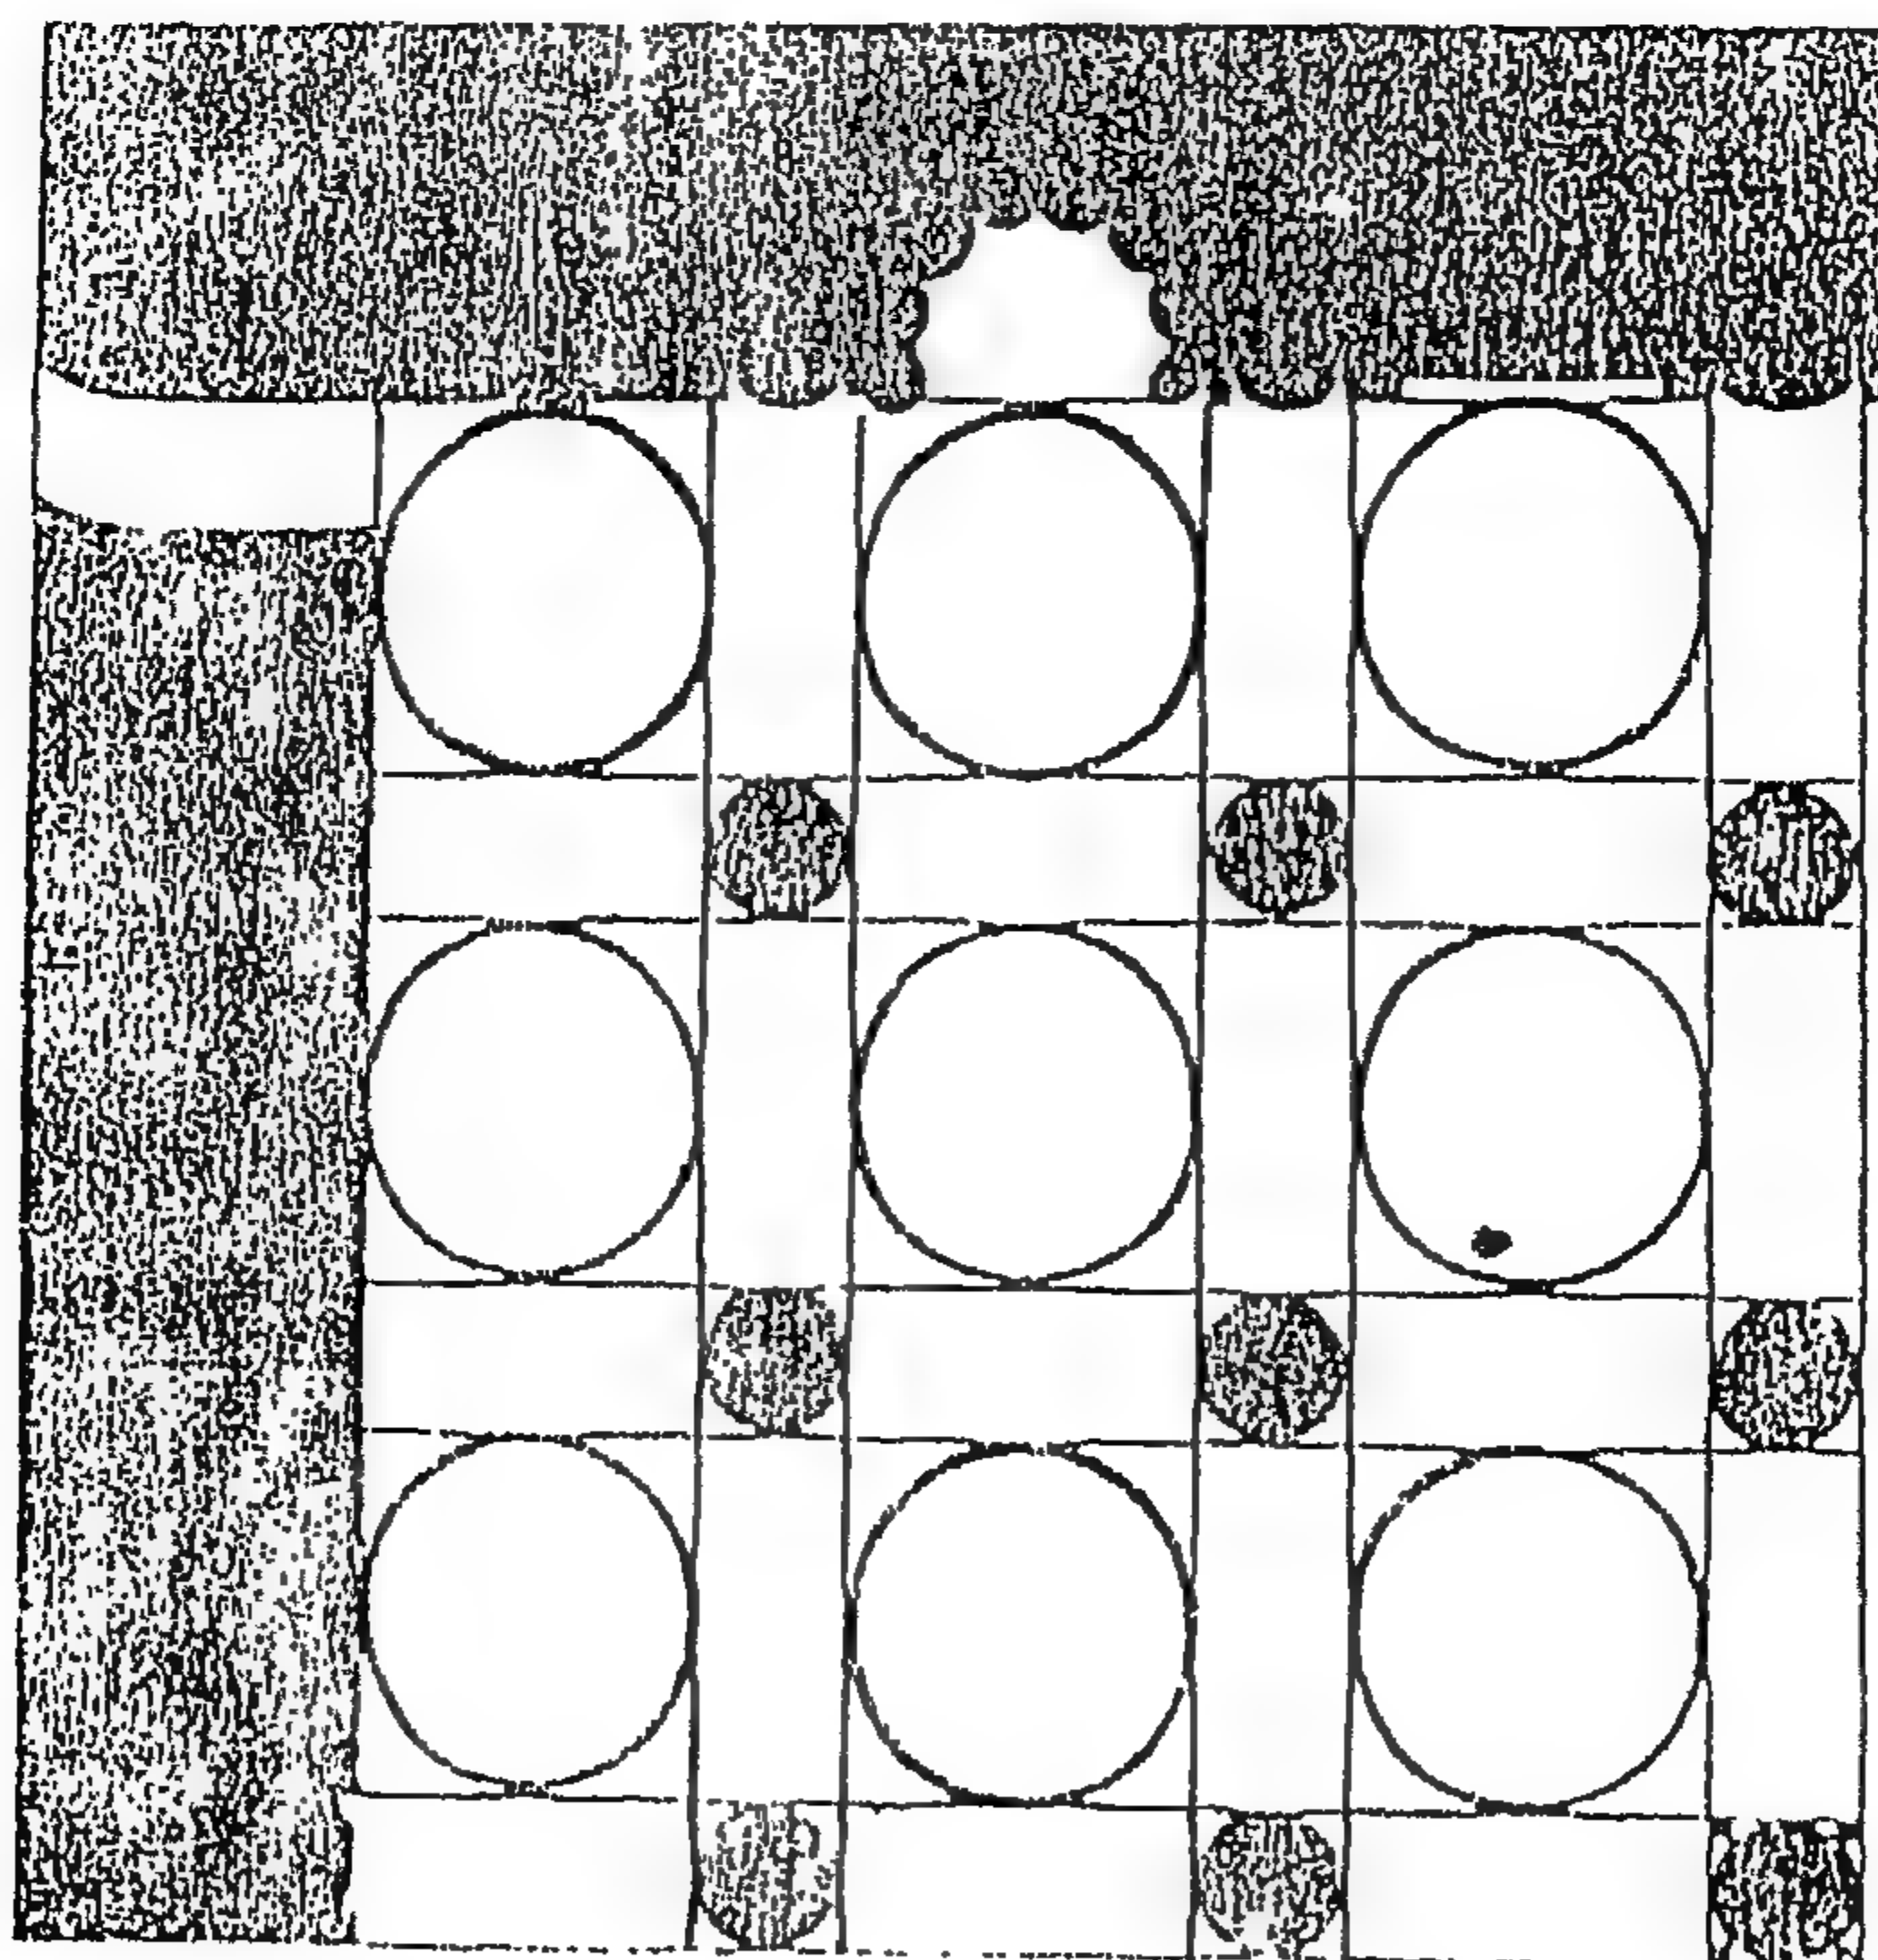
مسقط أفقي لمسجد القلعة بأرضروم أواخر ق ٦هـ / ١٢م وأوائل ق ٧هـ / ١٣م (عصر السلطقيين) - (عن : أصلان آبا).
